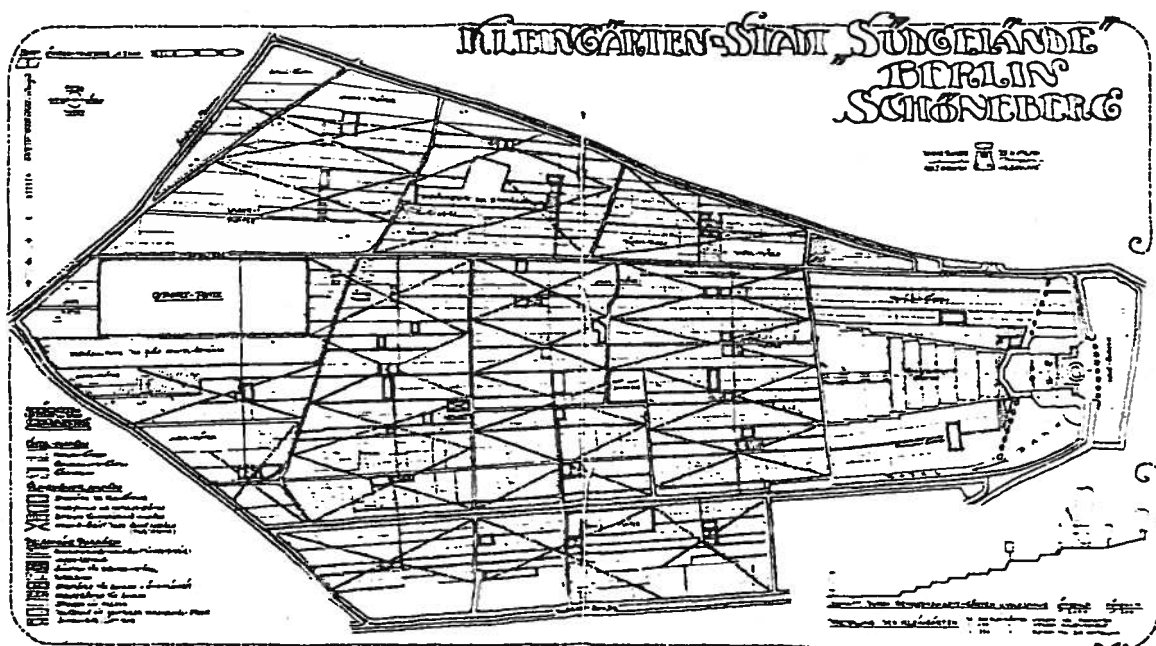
Planimetria della città dei giardini operai nel Sudgelände di Berlino-Schöneberg (progetto di L.Miggé, 1920).
